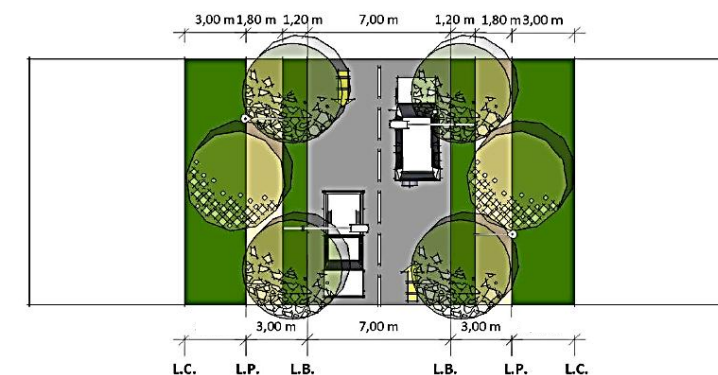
Planta del Perfil Vía Local. Equipo Asesor PP.
